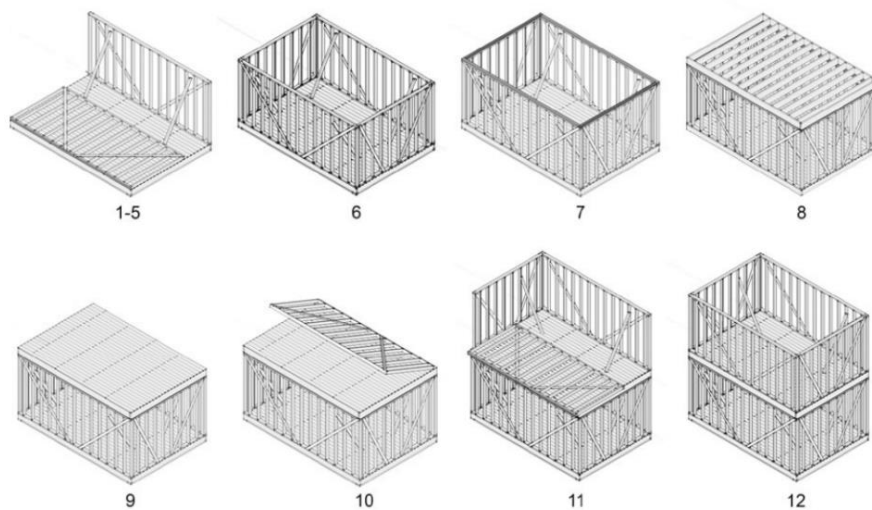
Etapas construtivas Platform Frame, Bastos (2019)
